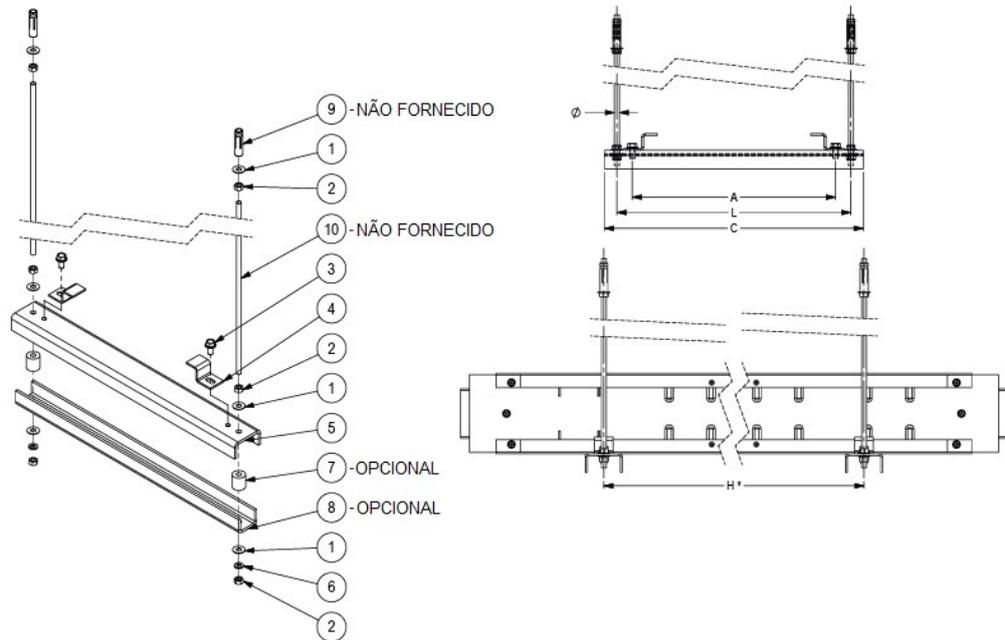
Suporte de sustentação/fixação horizontal para laje.
